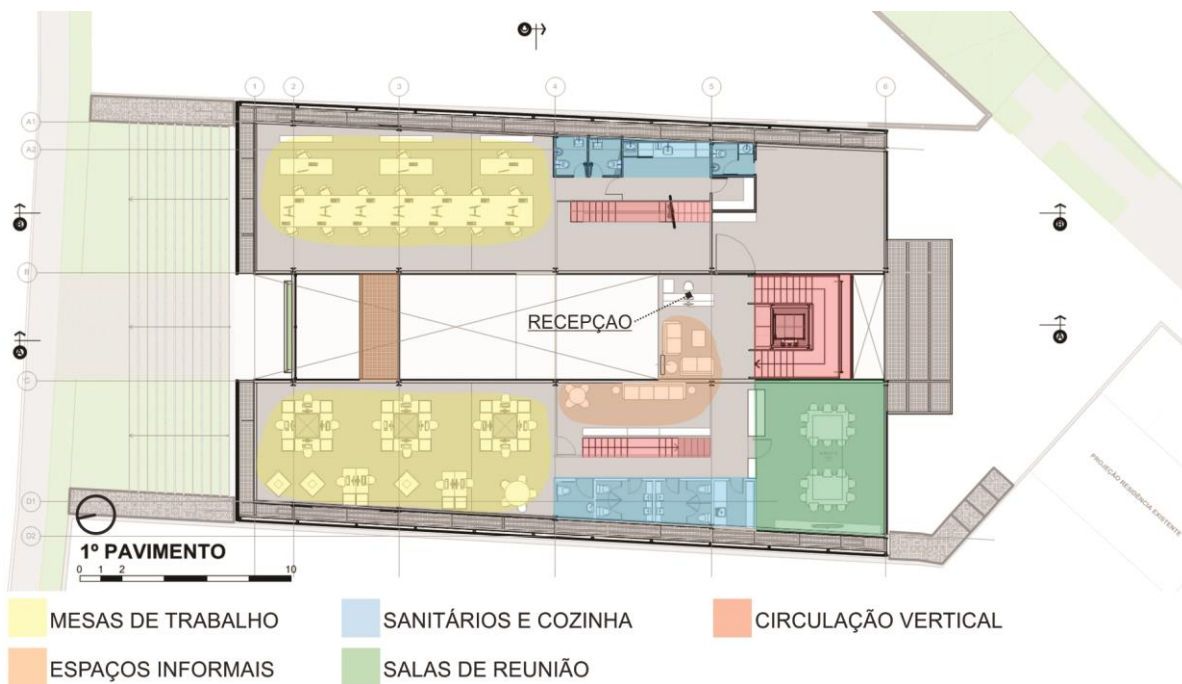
Edifício Oxi – Planta baixa do primeiro pavimento.
